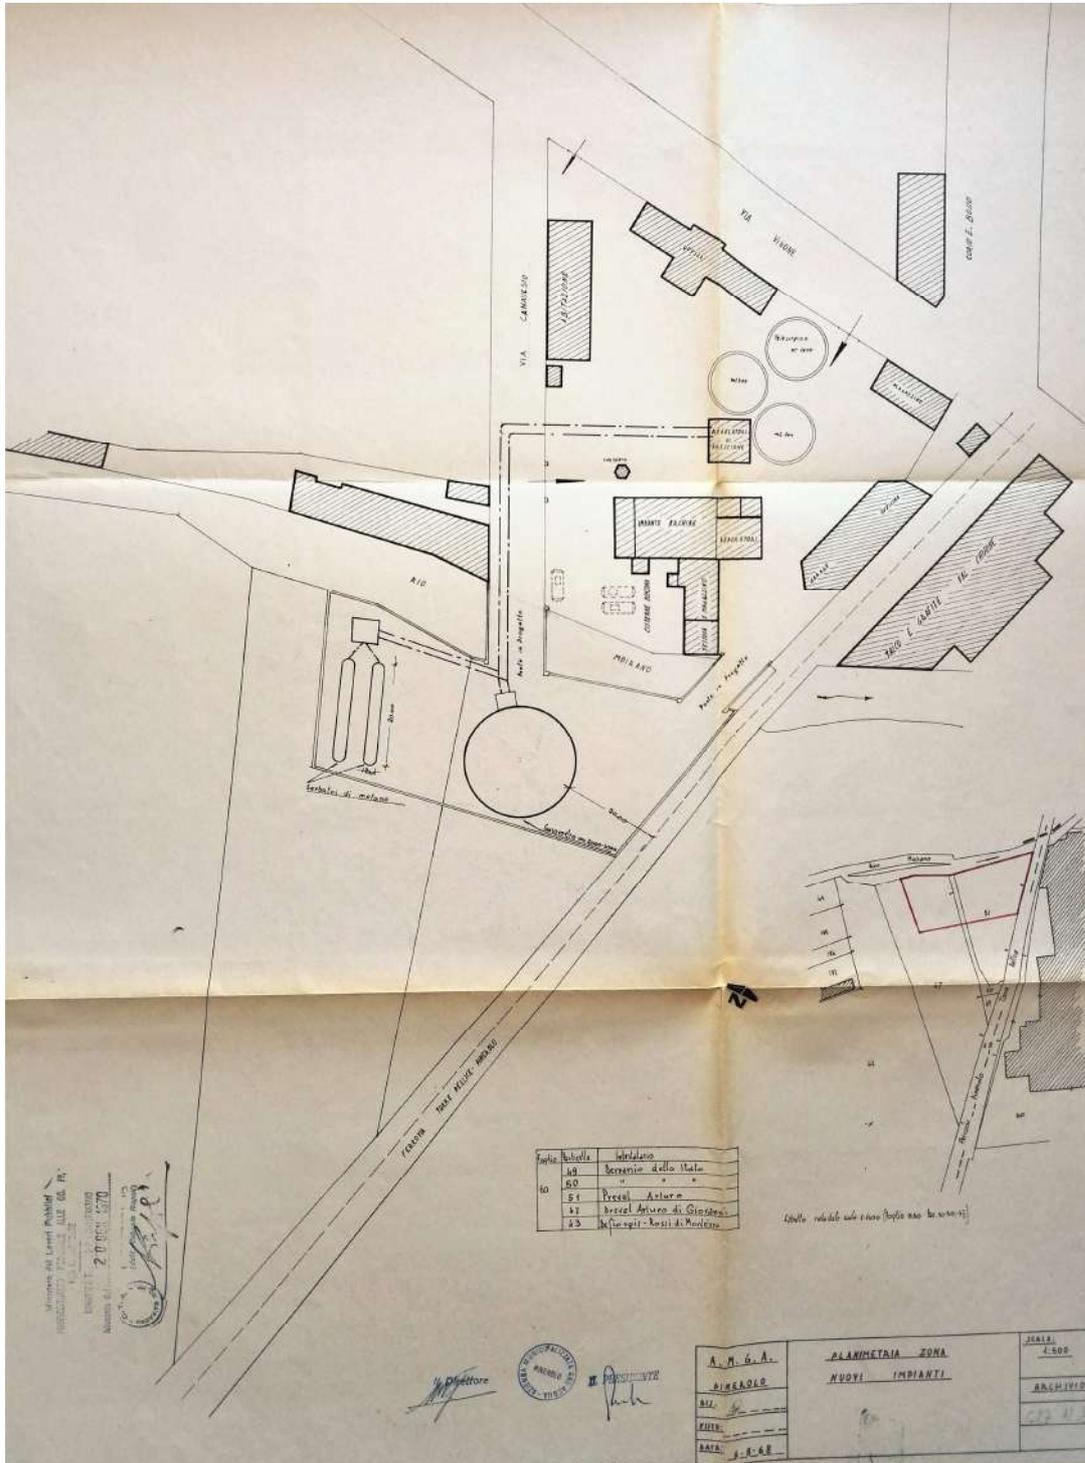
Planimetria zona nuovi impianti e veduta del complesso impianto cracking, AMGA 1968 (Acea Pinerolese Industriale Spa, Archivio storico)
